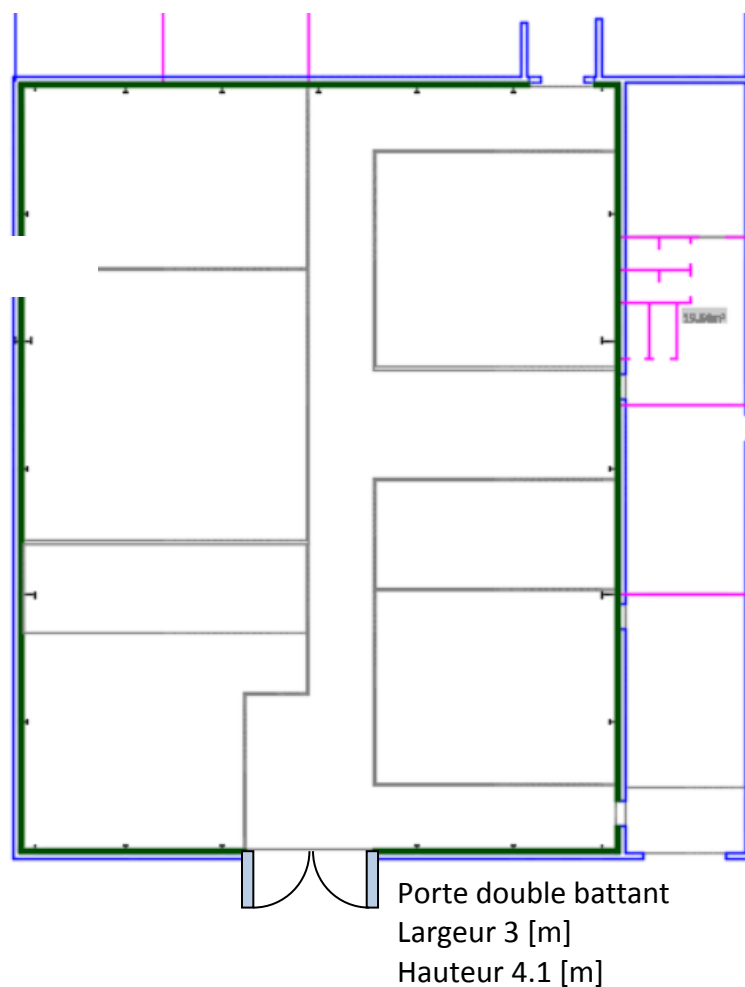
Plan du bâtiment 704, gabarit de passage.
